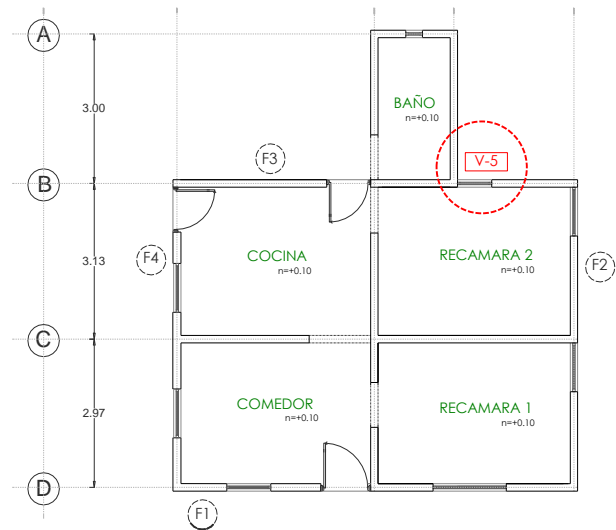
Plano de localización de Ventanas en Fachada Oeste.
